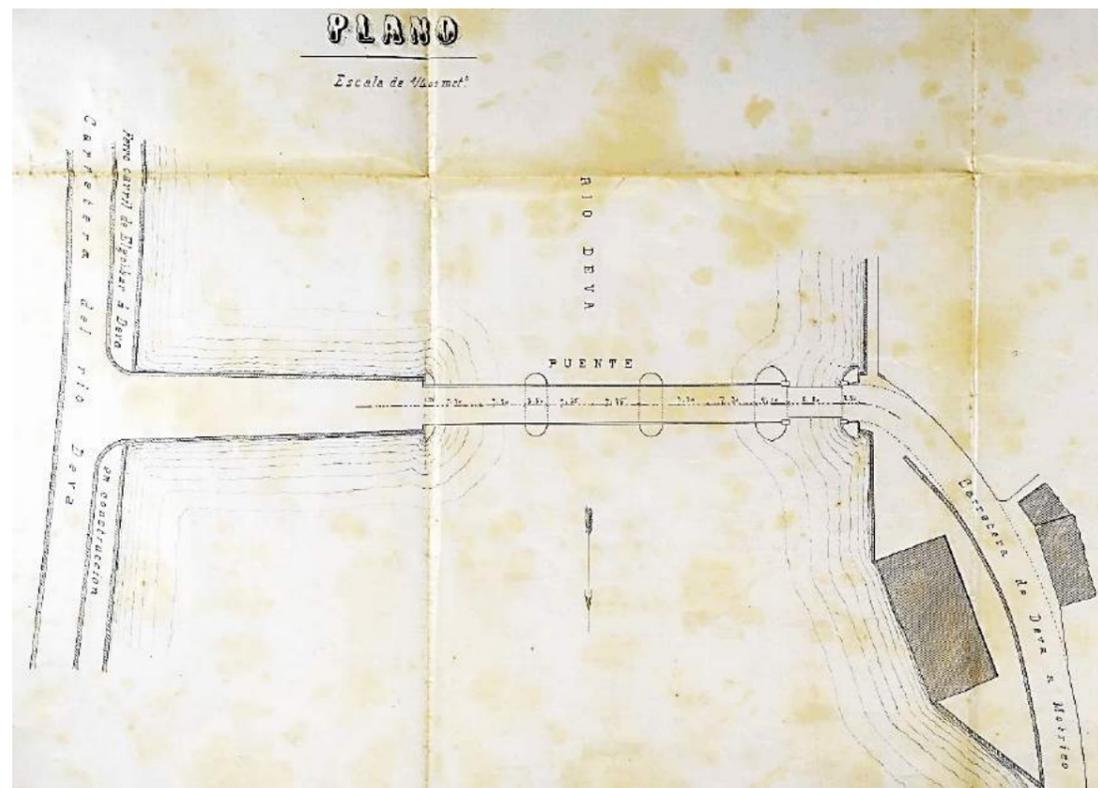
Planta del puente tomada de los planos del proyecto de reparación de 1892-1893 (ver referencia [1]).
